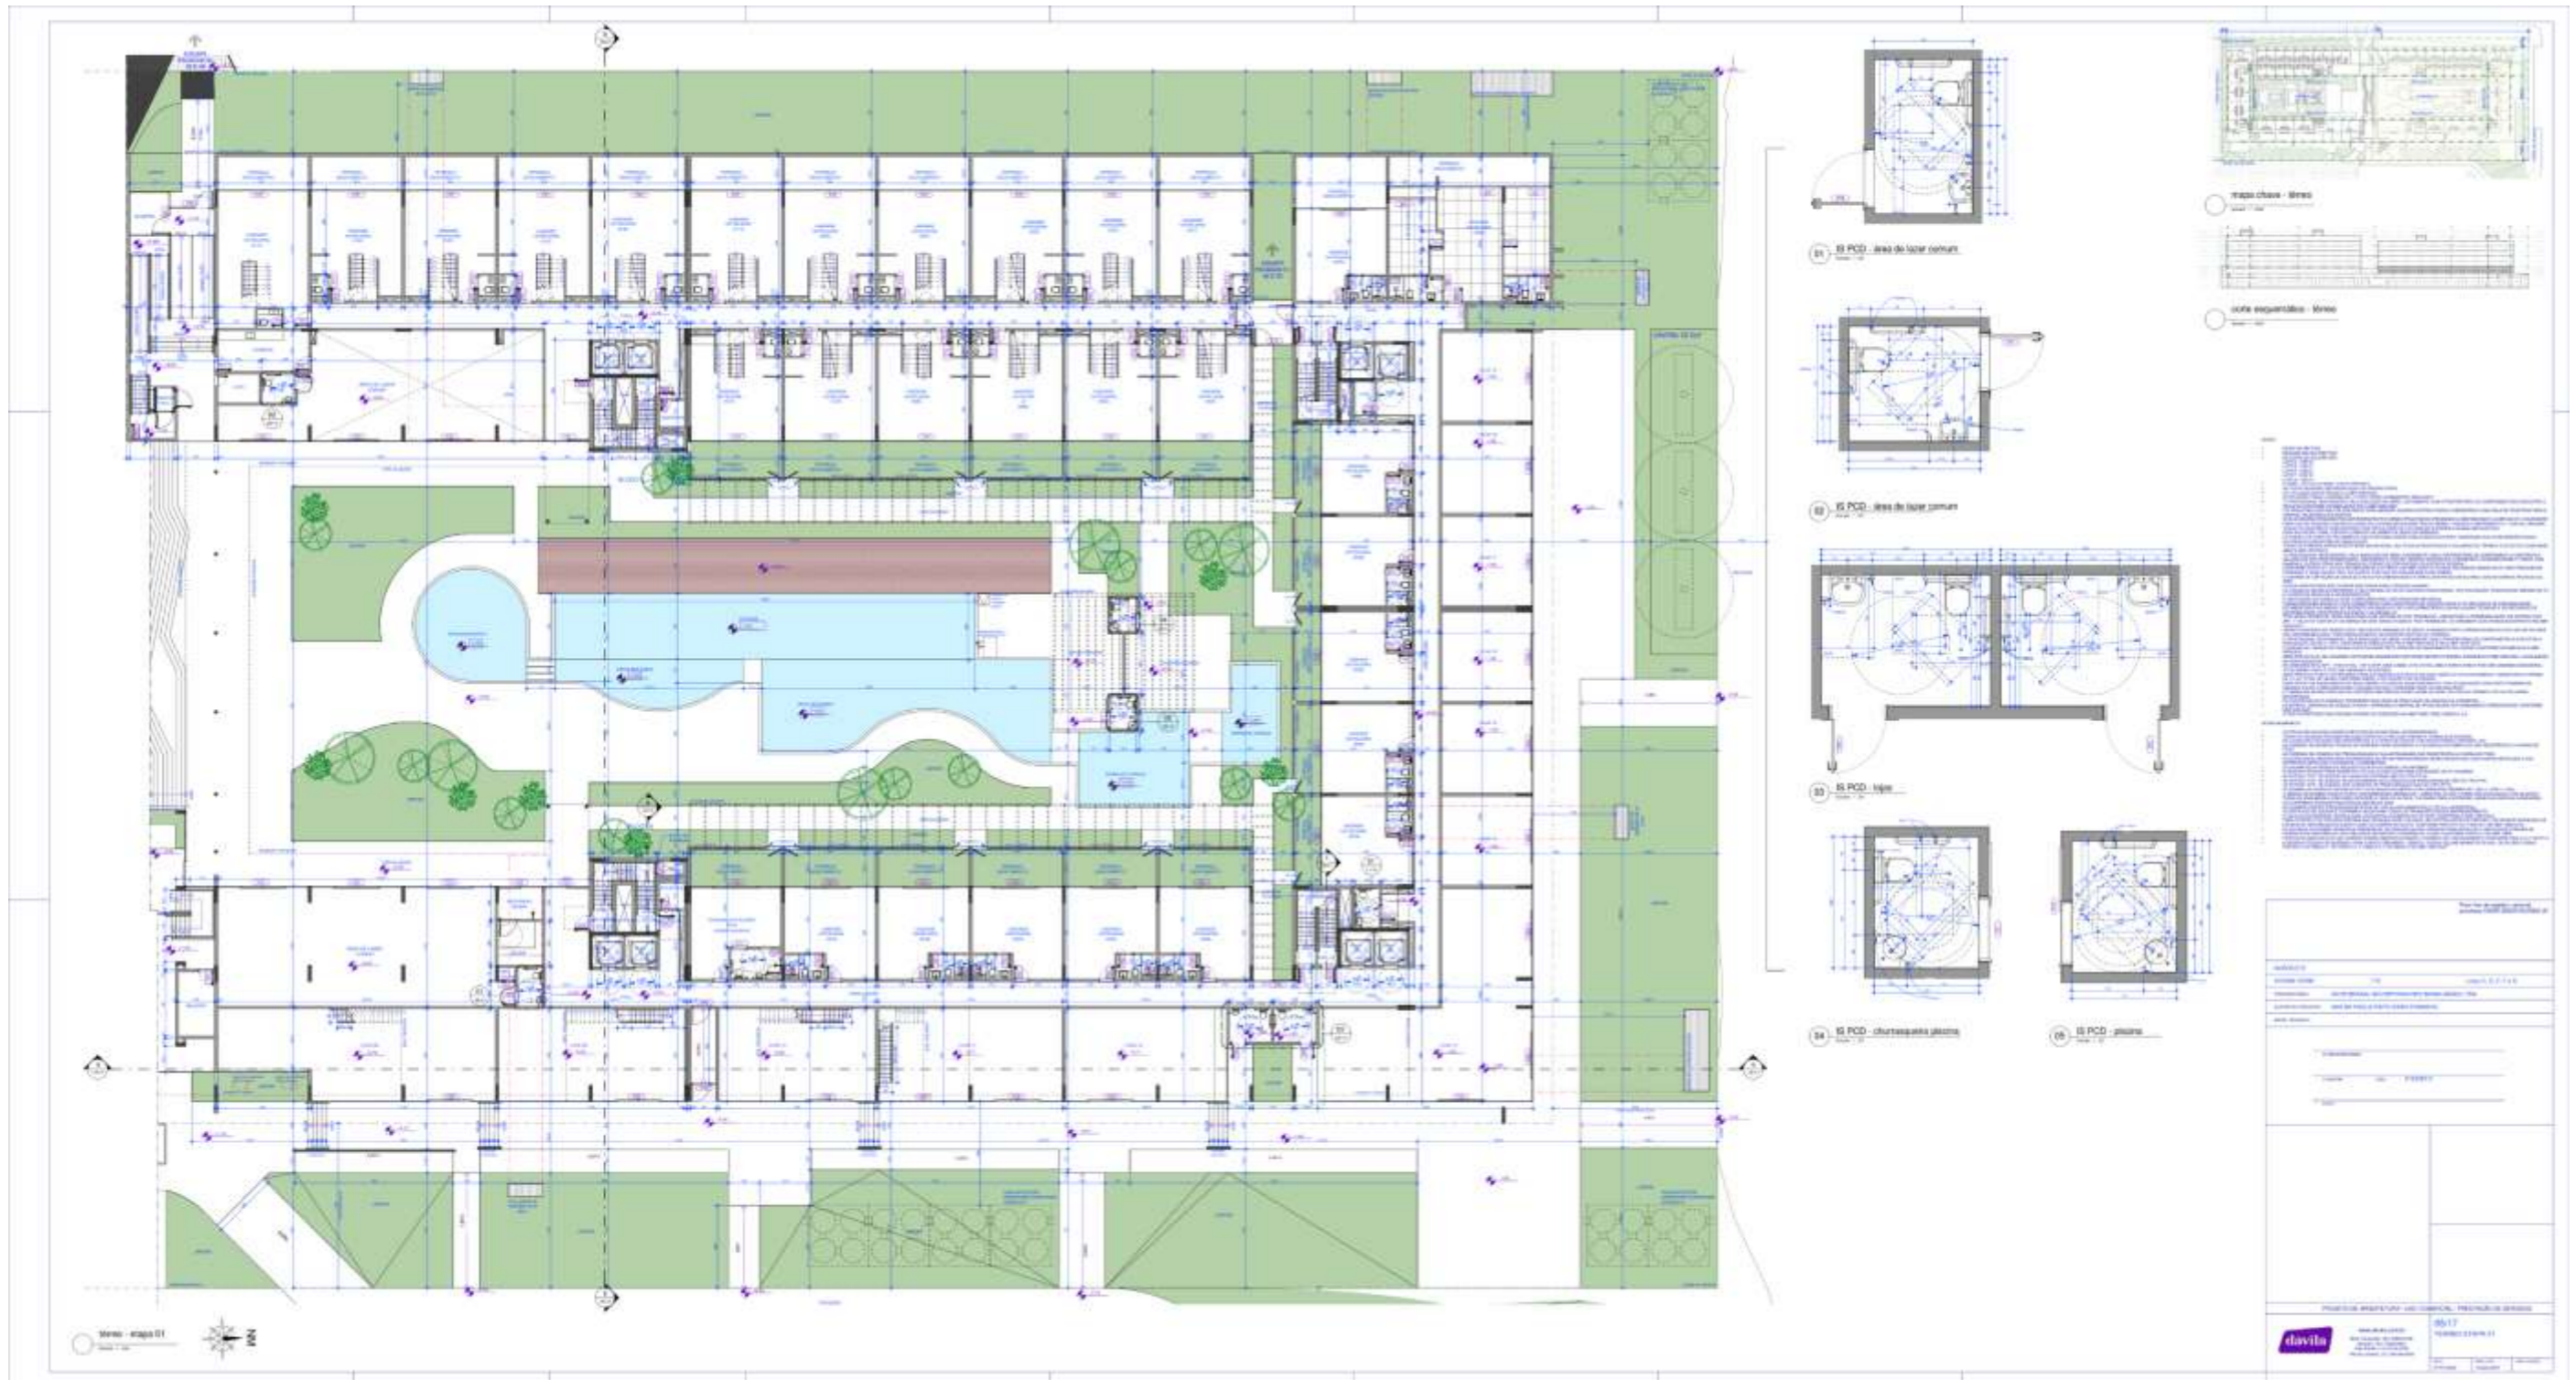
Planta do Térreo – Etapa 1. Fonte: Estudo Preliminar, em anexo.
